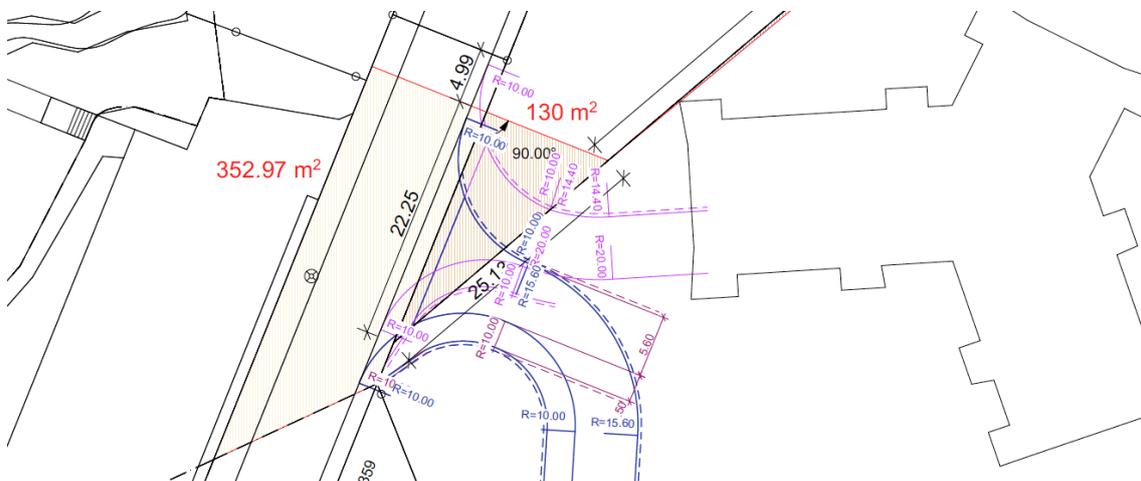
Zufahrt Variante 1 (blau) und Variante 4 (pink), TEAMverkehr, 27.10.2021 im Plan von Armon Semadeni Architekten 12.11.2021
